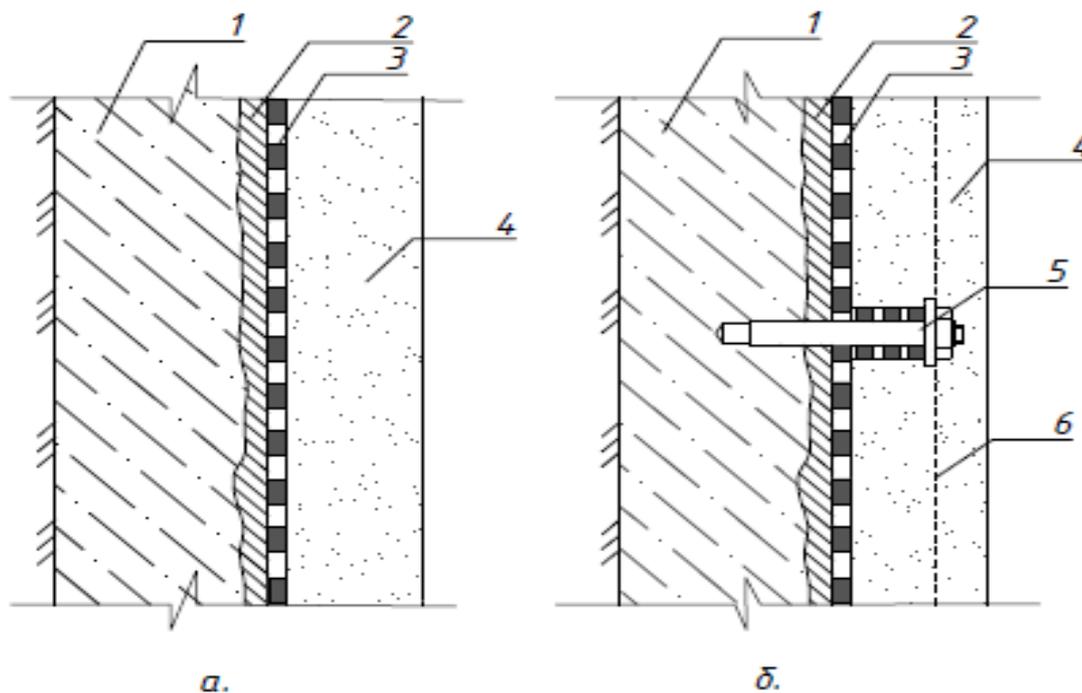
Гидроизоляция несущей "стены в грунте", при возведении подземных сооружений открытого и полужакрытого способов работ
